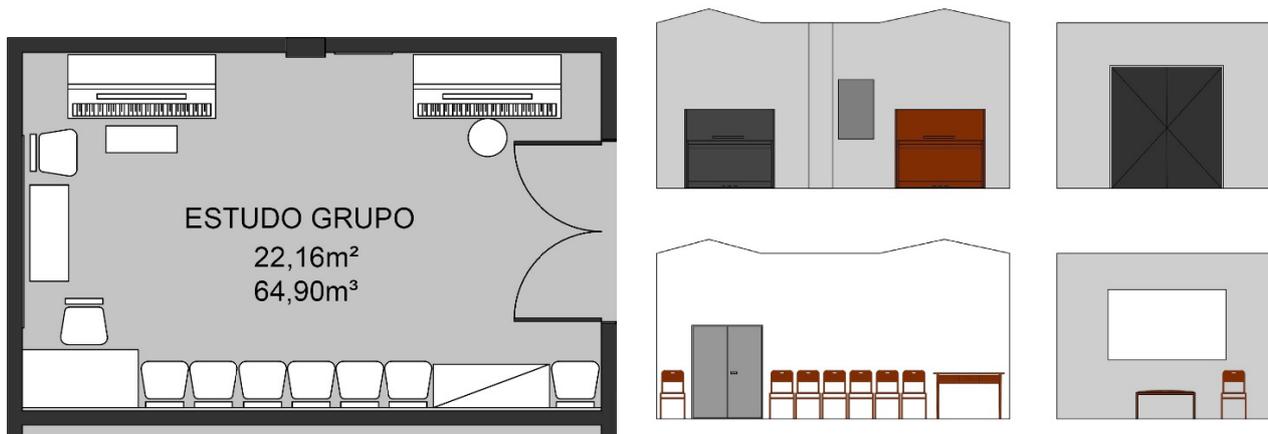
Planta baixa e elevações da sala 09. Sem escala.
